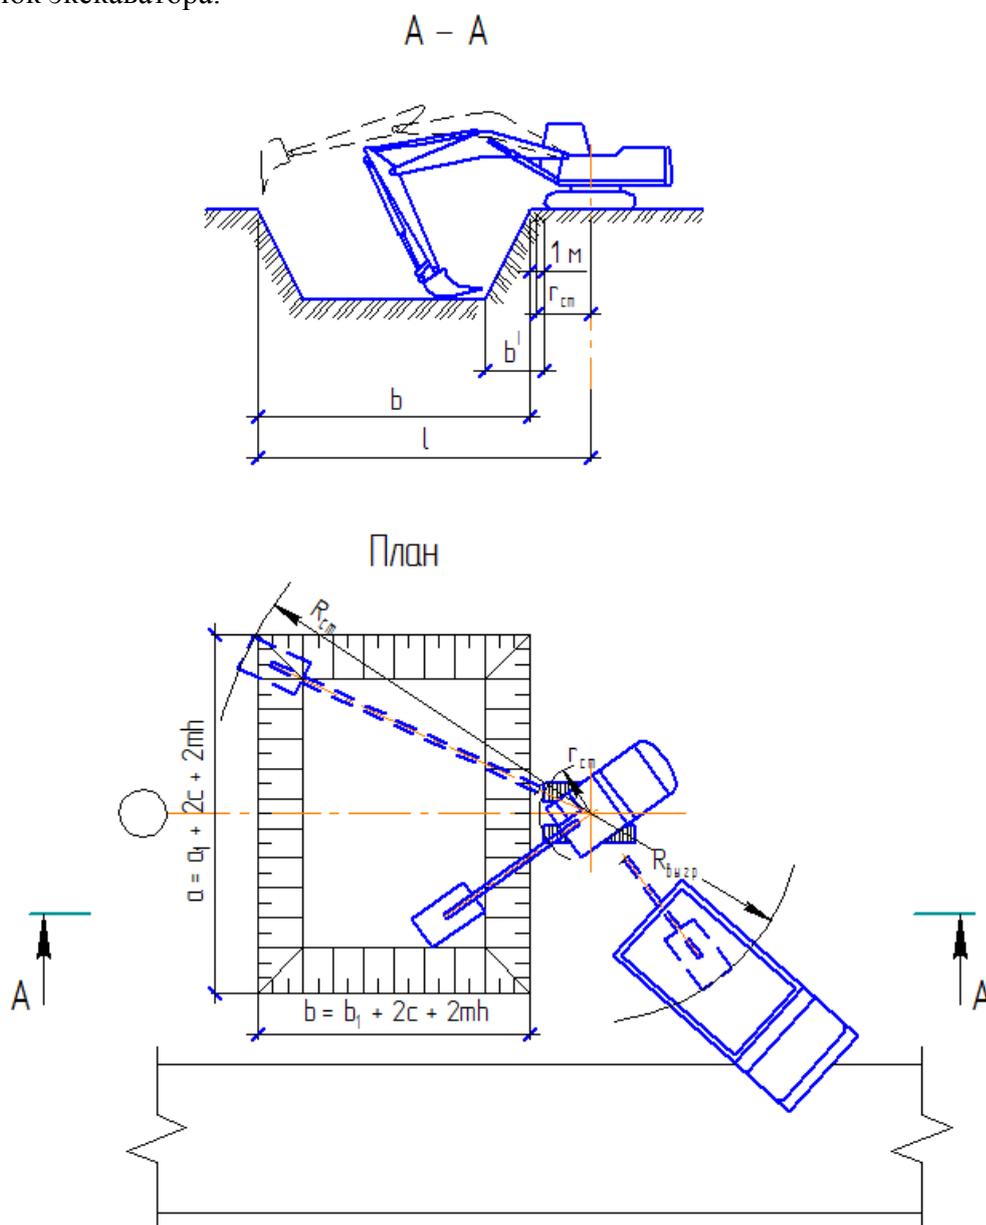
Схема разработки котлована под один фундамент с одной стоянки
